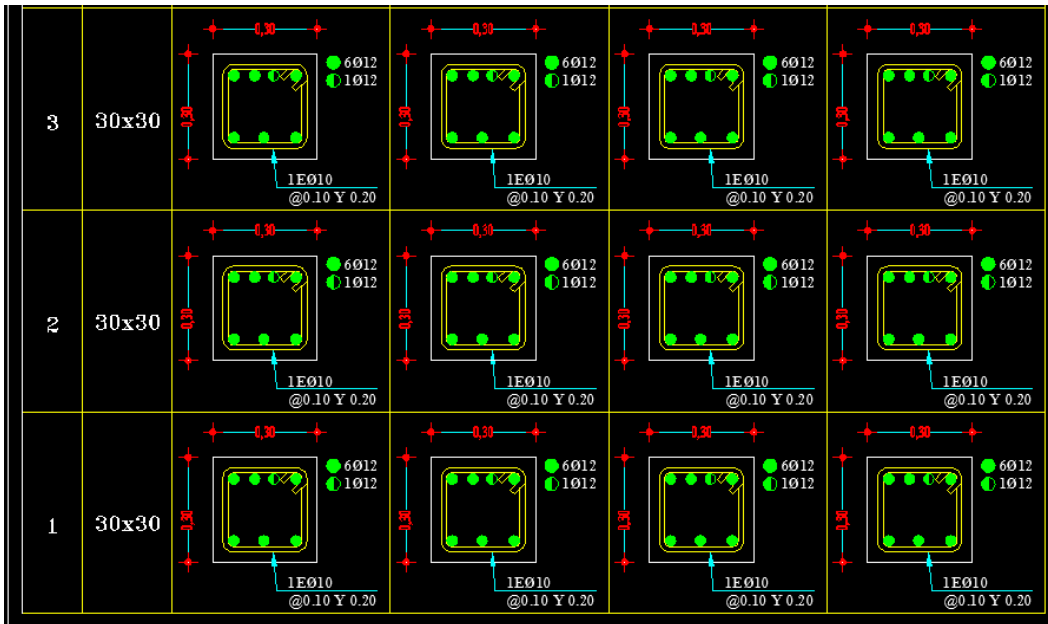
Armadura de las Vigas Edifi. 6 Pisos
